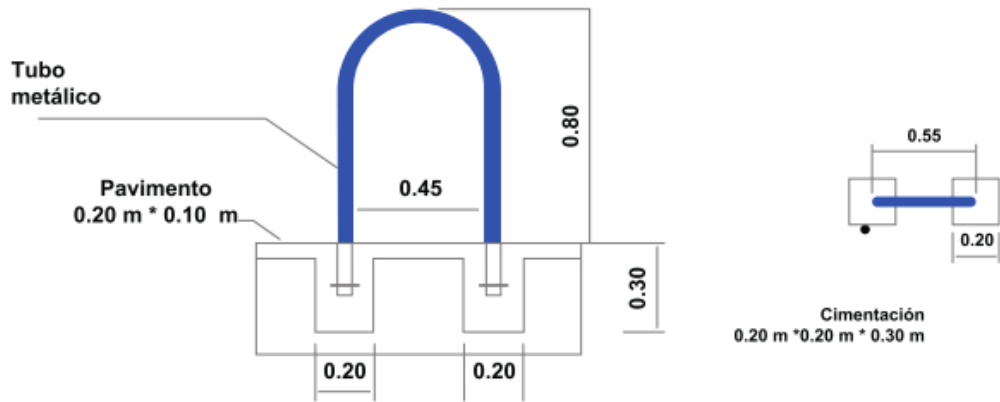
Plano de detalle de tubo metálico en cicloparqueador
